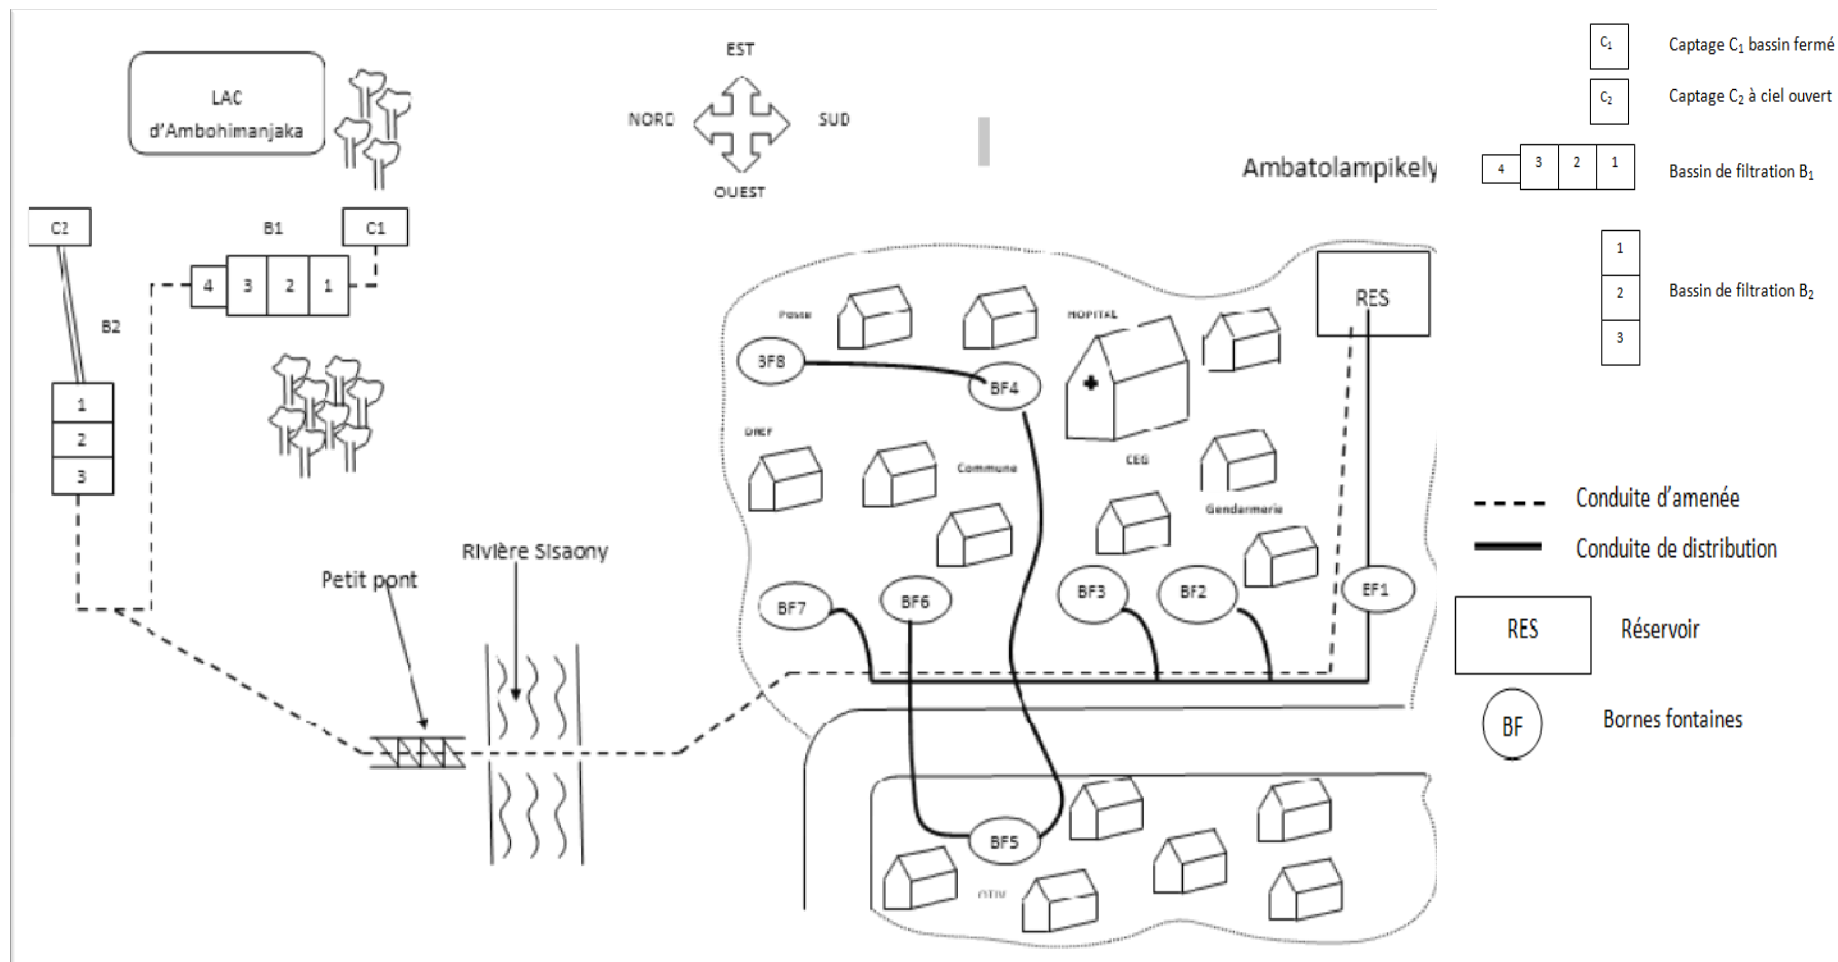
Plan d'adduction d'eau potable par gravitaire de la ville d'Andramasina, 2016
